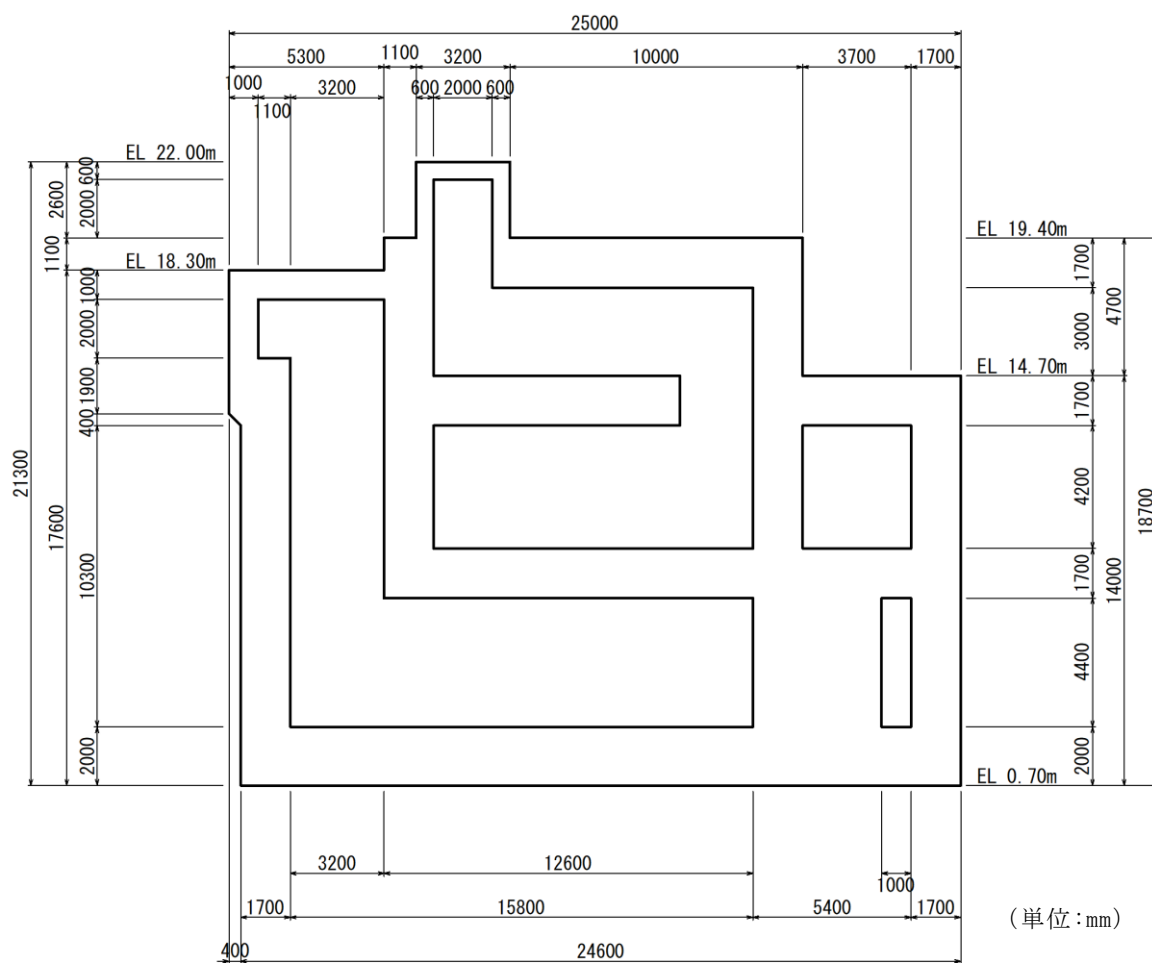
第 1 ベントフィルタ格納槽 断面図 (F-F 断面)
